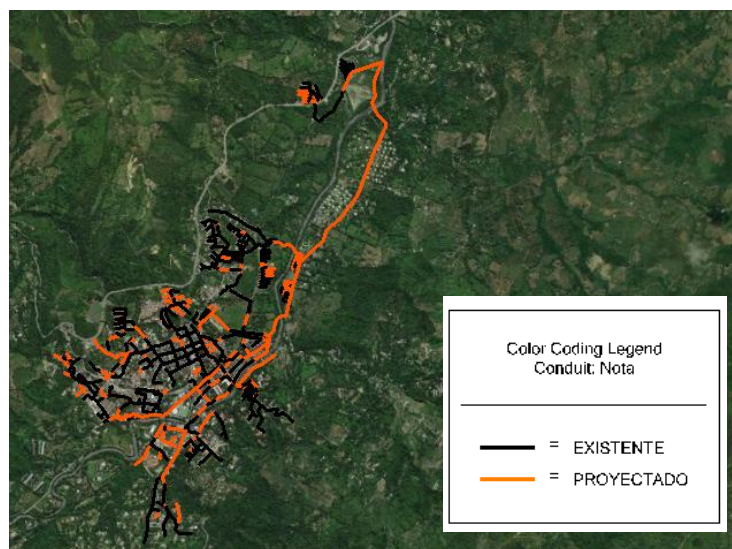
Redes proyectadas de alcantarillado sanitario.
